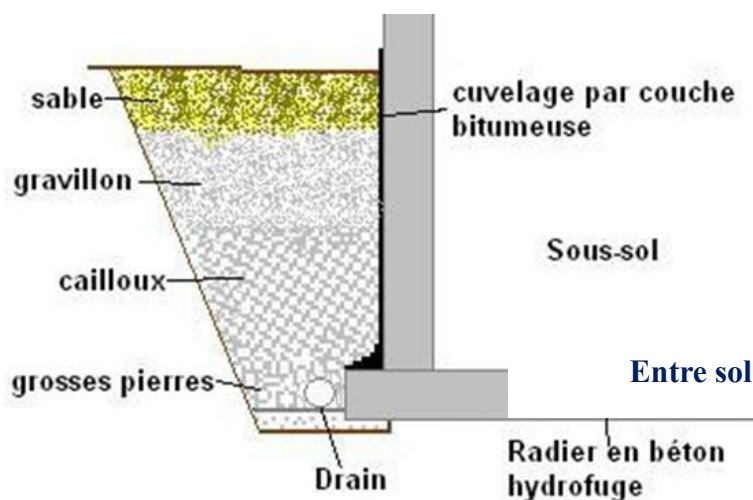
Détail d'un mur de soutènement reposant sur un radier
